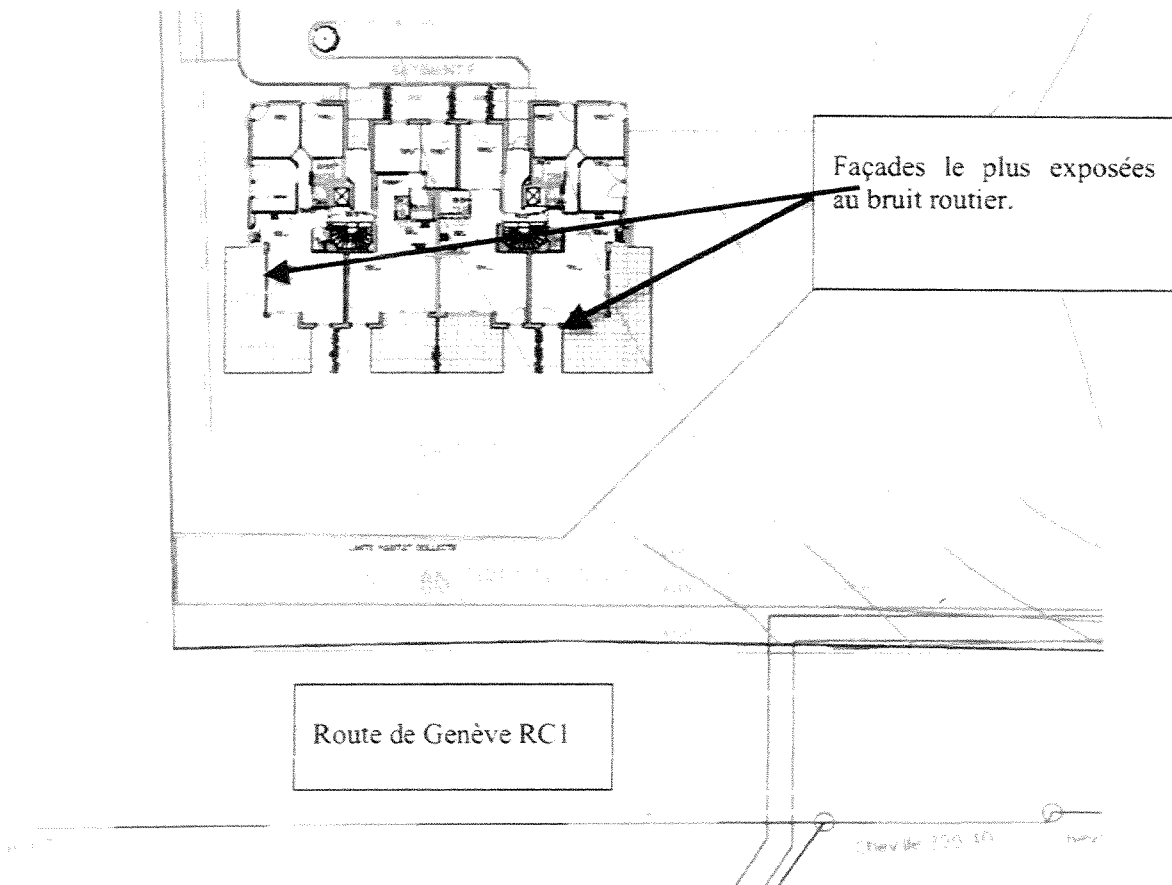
plan de situation général du bâtiment exposé au bruit de la RC1
